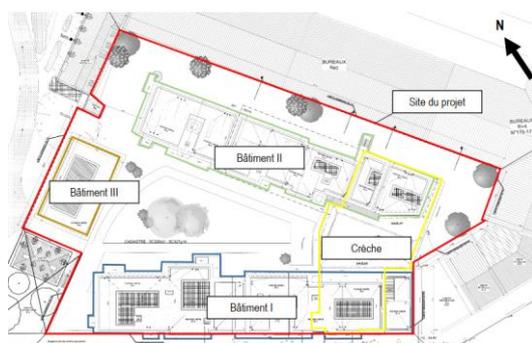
Plan d'implantation du projet précédent (ARIES sur fond de plan Accarain-Bouillot, 2018)
